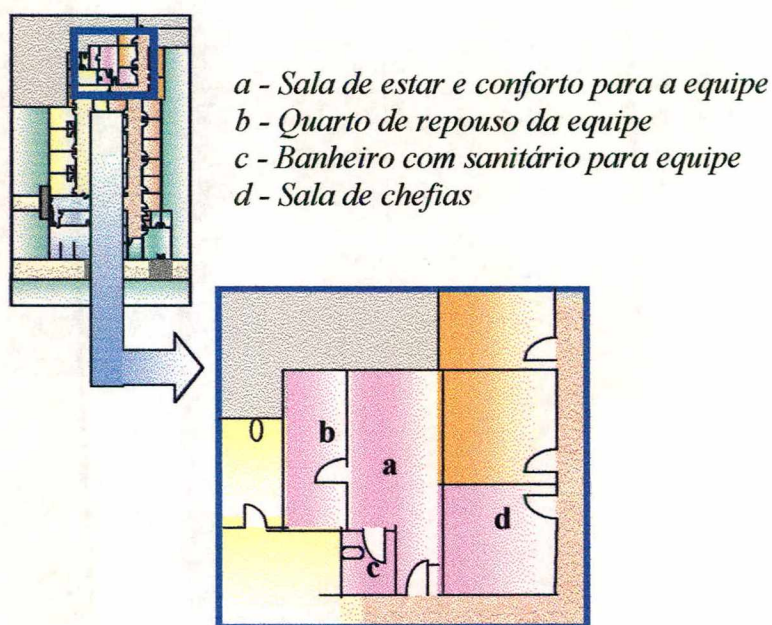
Vista parcial dos locais e espaços de trabalho após as alterações propostas, área correspondente ao subsistema 6.
